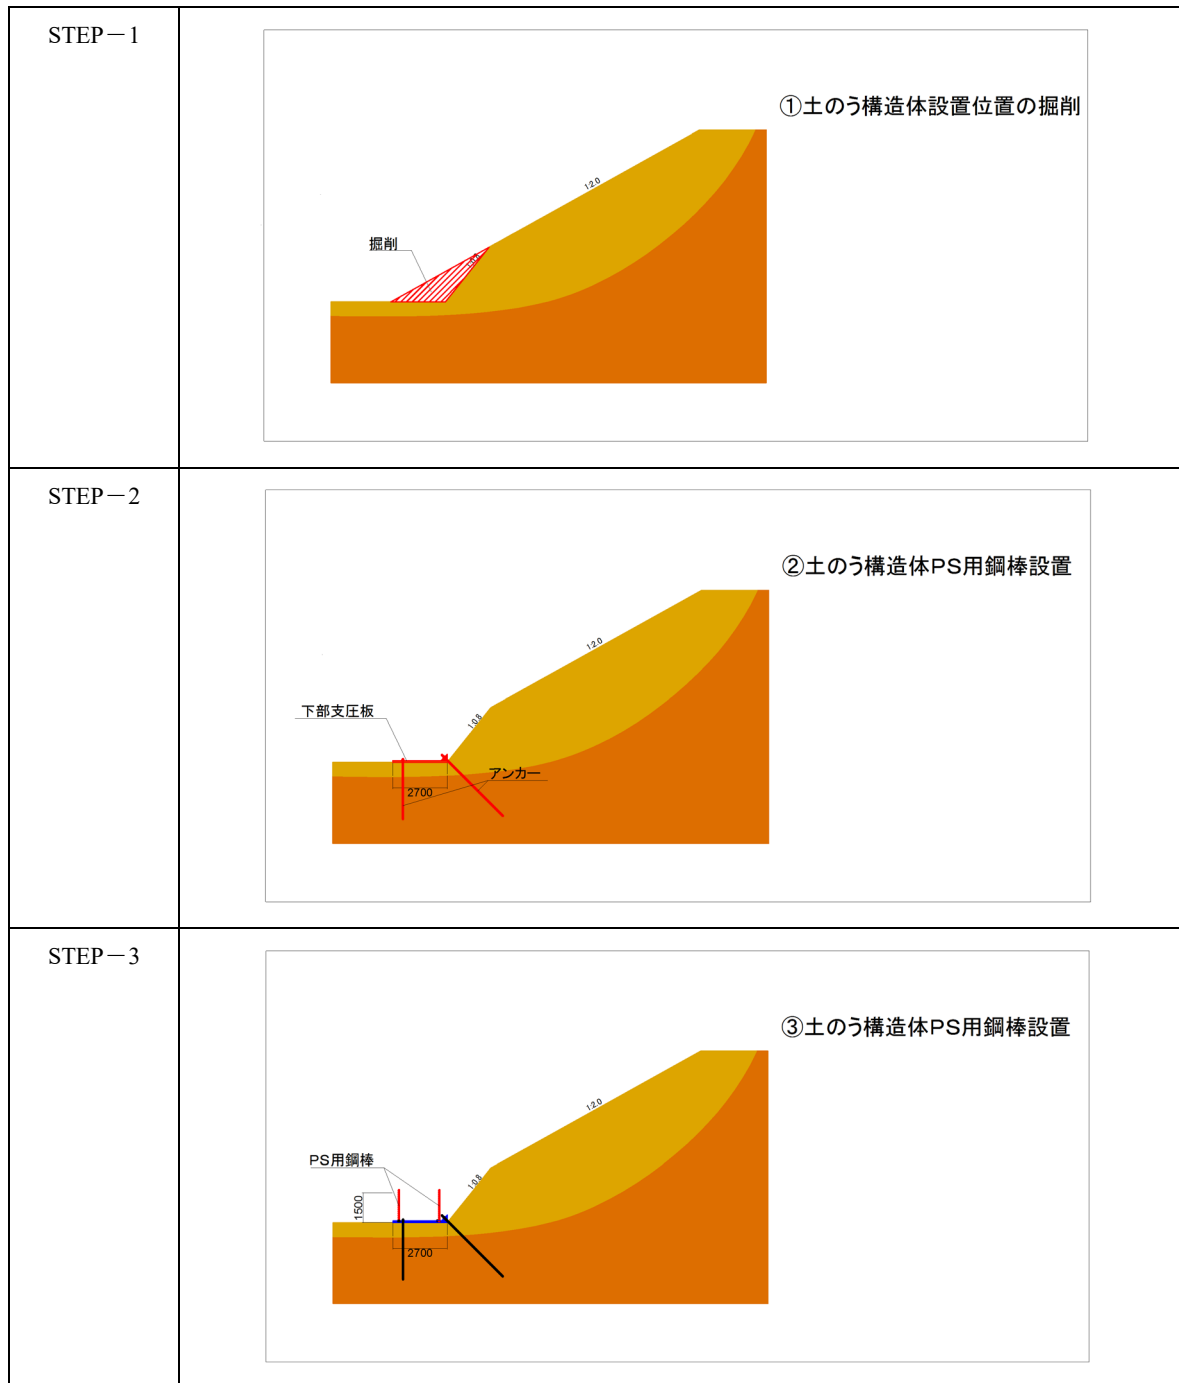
(a) 「多段式」盛土法先補強工法の施工順序図（その1）
